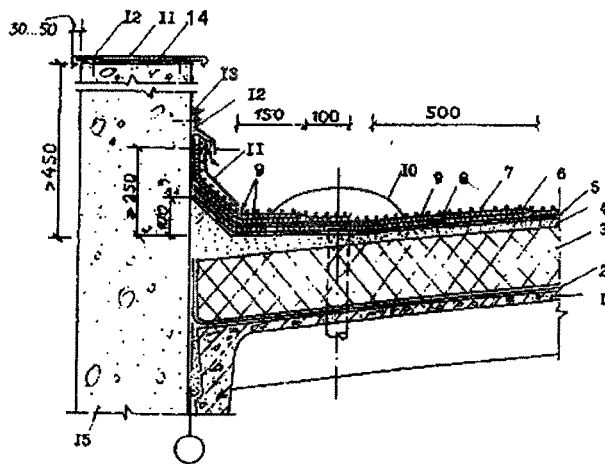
Примыкание кровли к парапету высотой более 450 мм при механическом закреплении нижнего слоя водоизоляционного ковра
